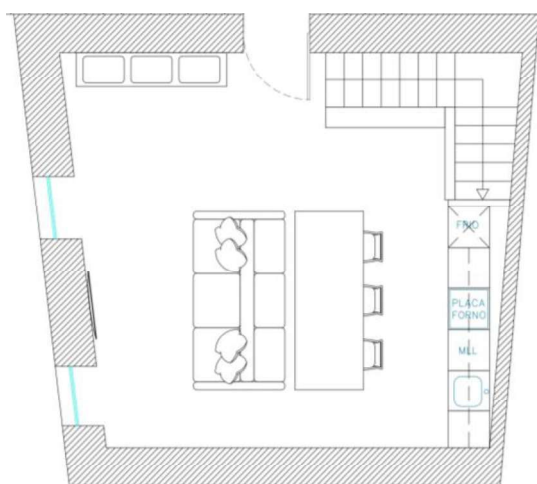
Planta do alojamento rural, proposta III, piso inferior. Fonte: Autor
